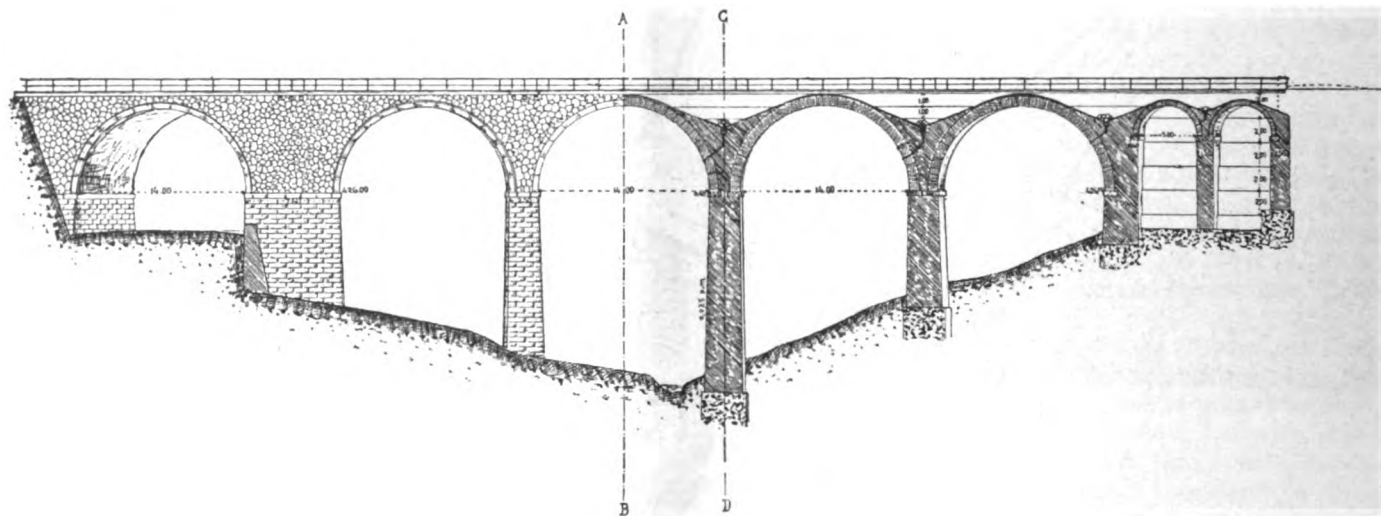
Viadotto di Bagnaia. - Prospetto e sezione longitudinale.
